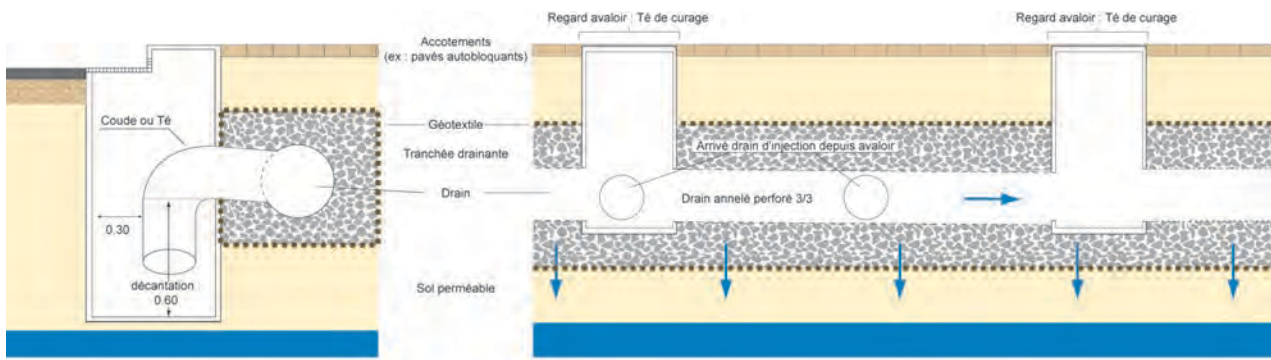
coupe en travers et profil en long d'une tranchée drainante/d'infiltration
